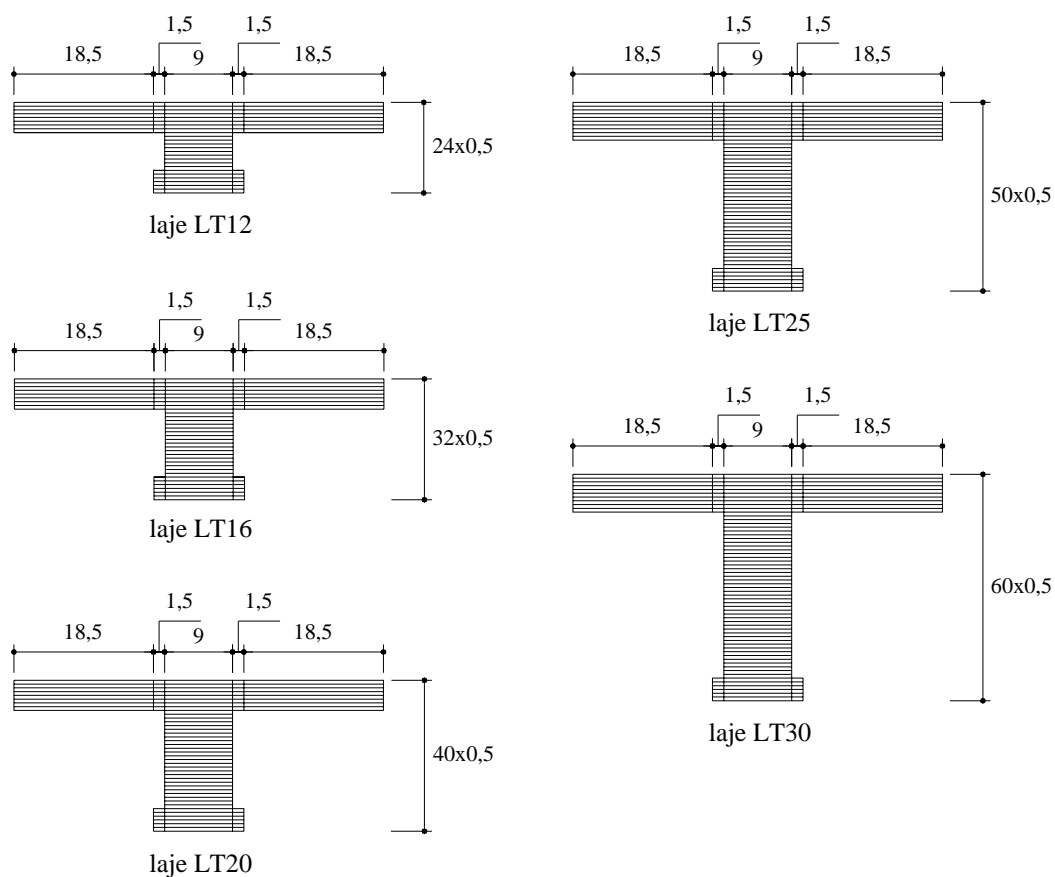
Discretização da seção transversal das lajes (dimensões em cm)
